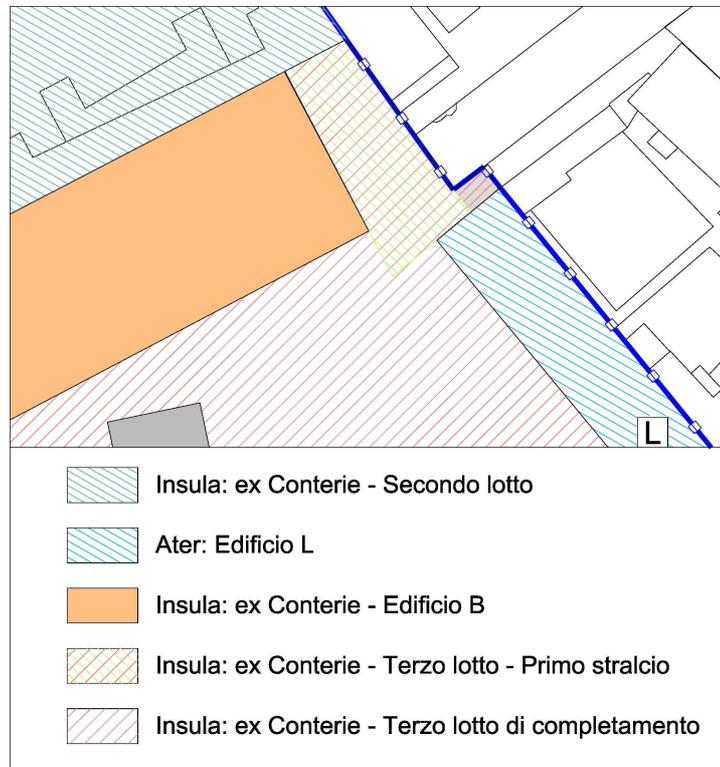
Area d'intervento “Terzo lotto primo stralcio: area adiacente edificio L”
